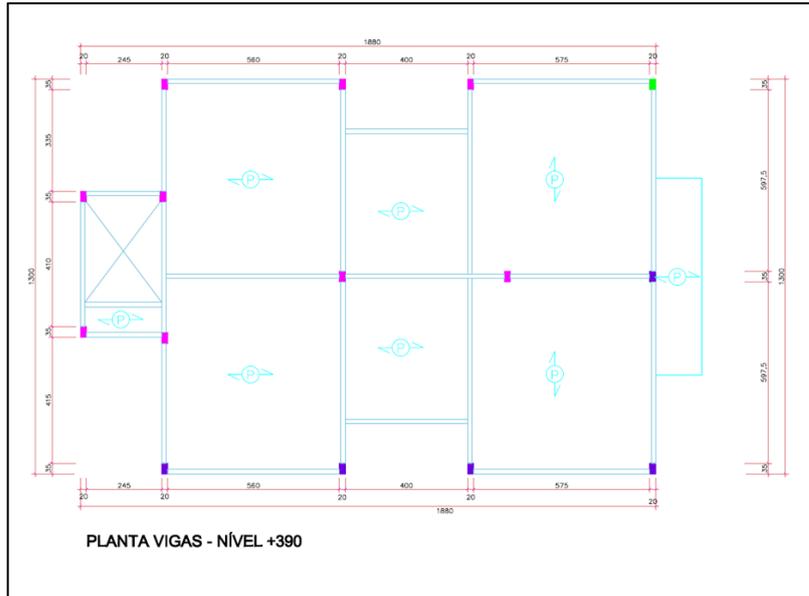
Projeto estrutural 01: Nível +3,90 m
